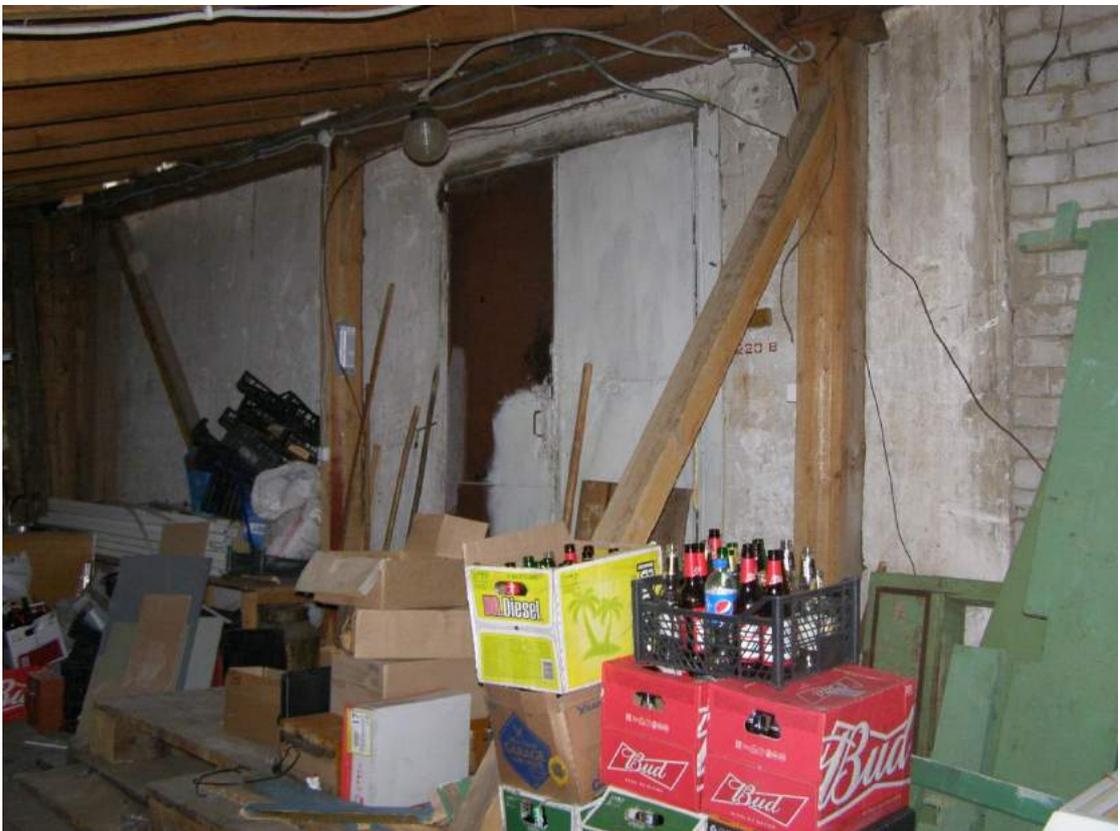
Внутренний вид здания магазина (складские помещения площадью 56,4 кв.м.)
